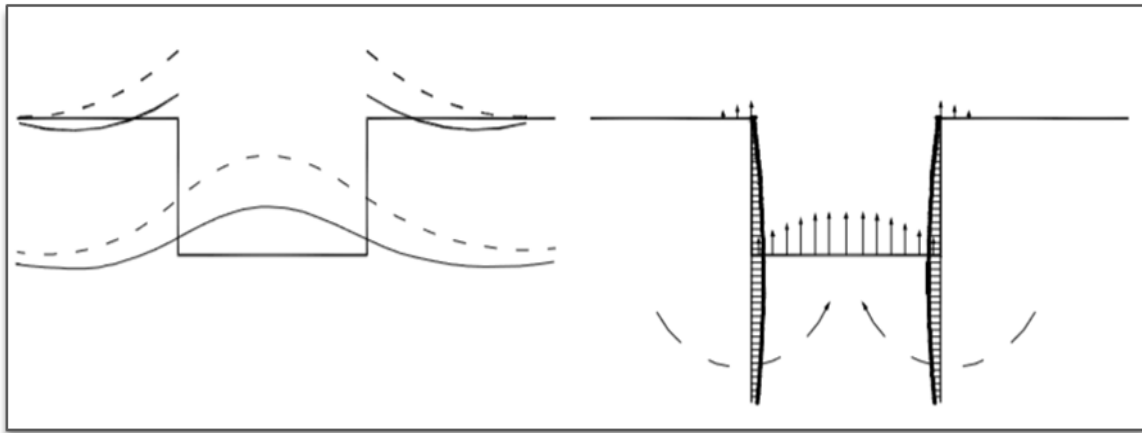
Déplacements horizontaux et verticaux autour de l'excavation.
